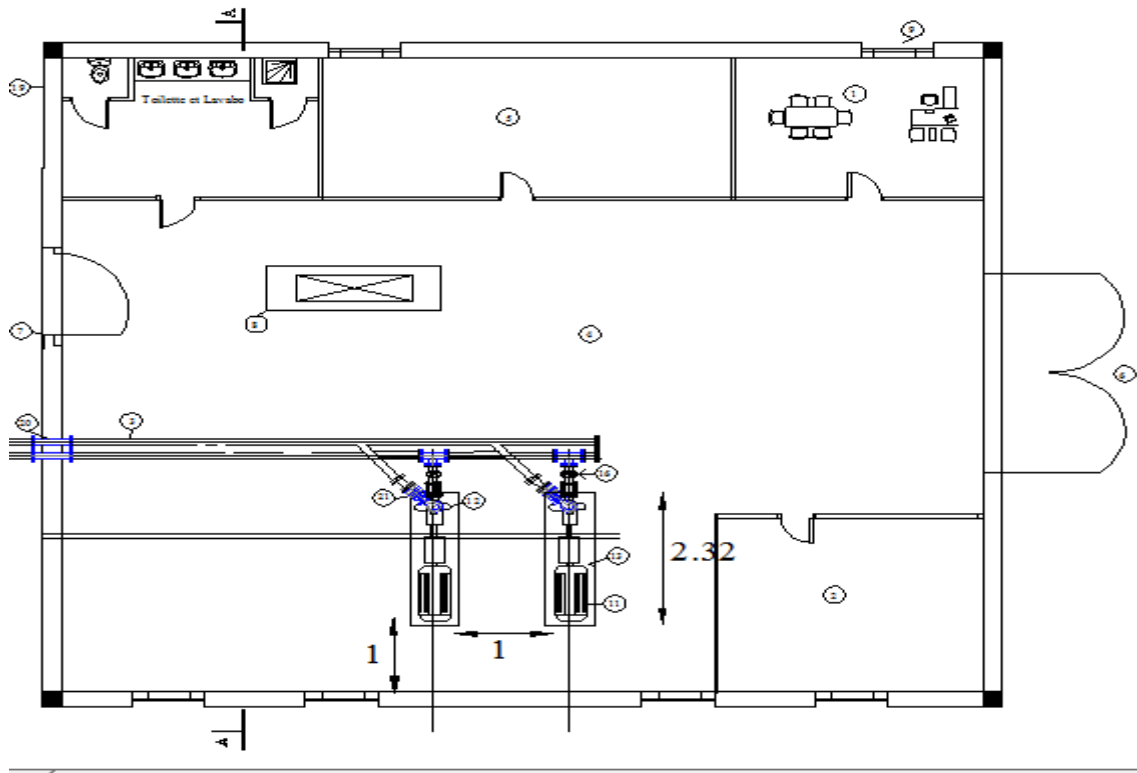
schéma explicatif du bâtiment de la station de pompage.
